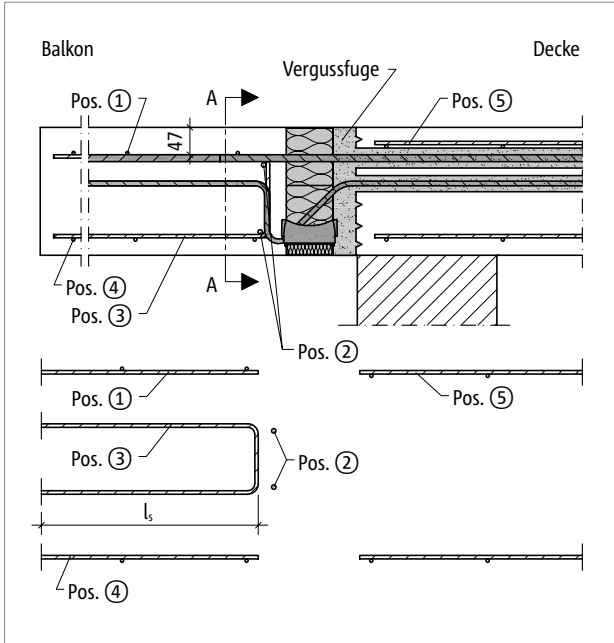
Schöck Isokorb® RT Typ K: Bauseitige Bewehrung bei direkter Lagerung
